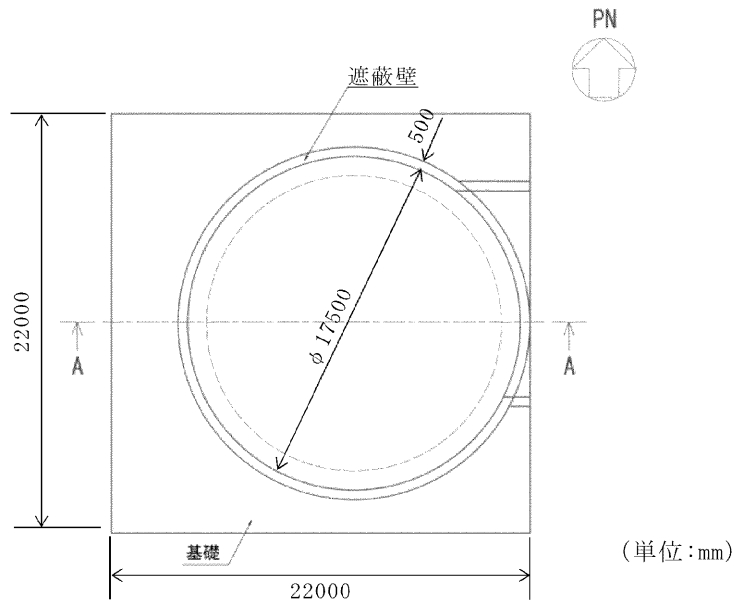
復水貯蔵タンク遮蔽壁 平面図
